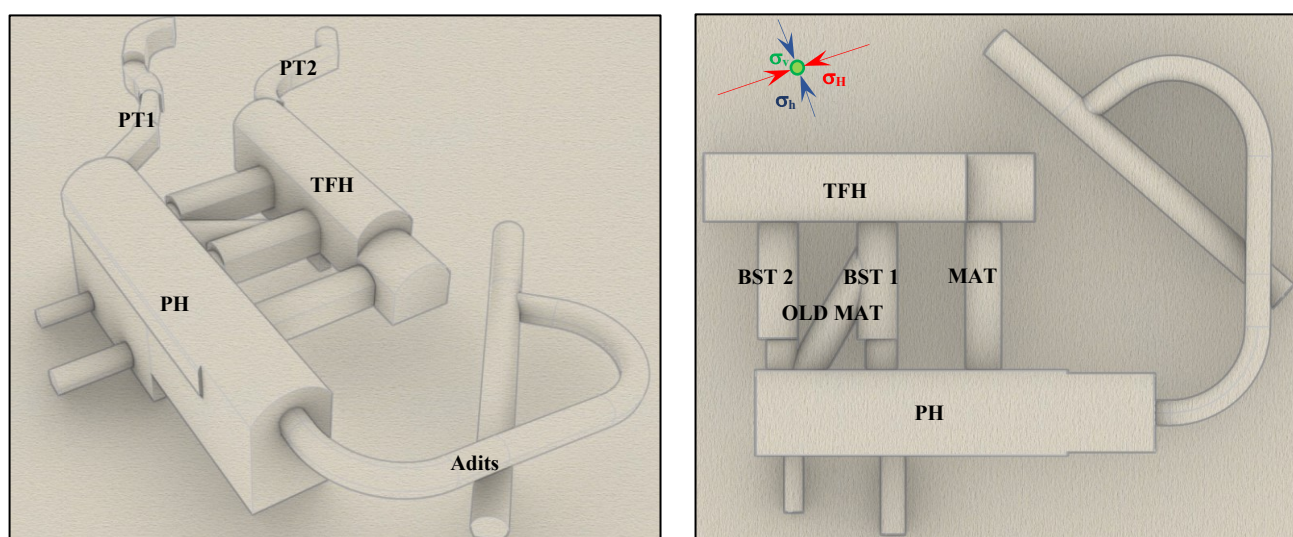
Vista in prospettiva (sx) e dall'alto (dx) del complesso di opere.
